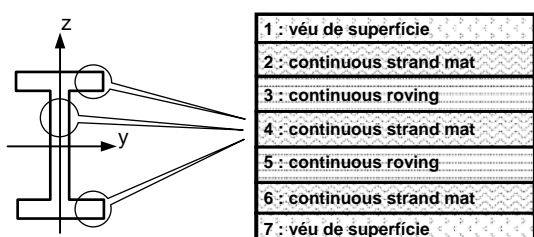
Configuração típica da seção de um perfil pultrudado.
